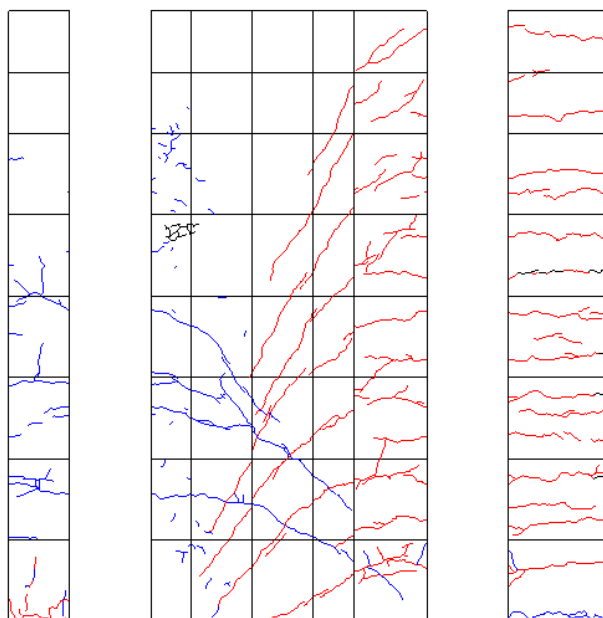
R=1/50 ひび割れ図
